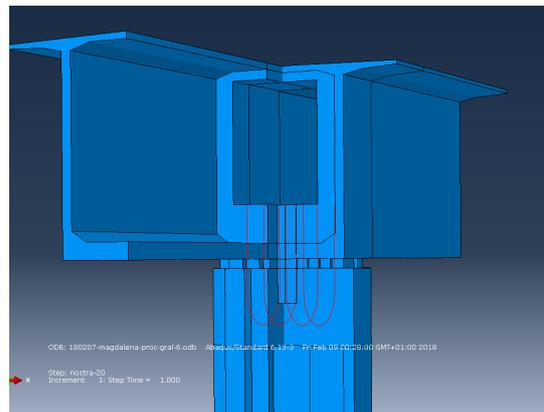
Distribución de cables de pretensado y sección de losa superior en dovela 1
